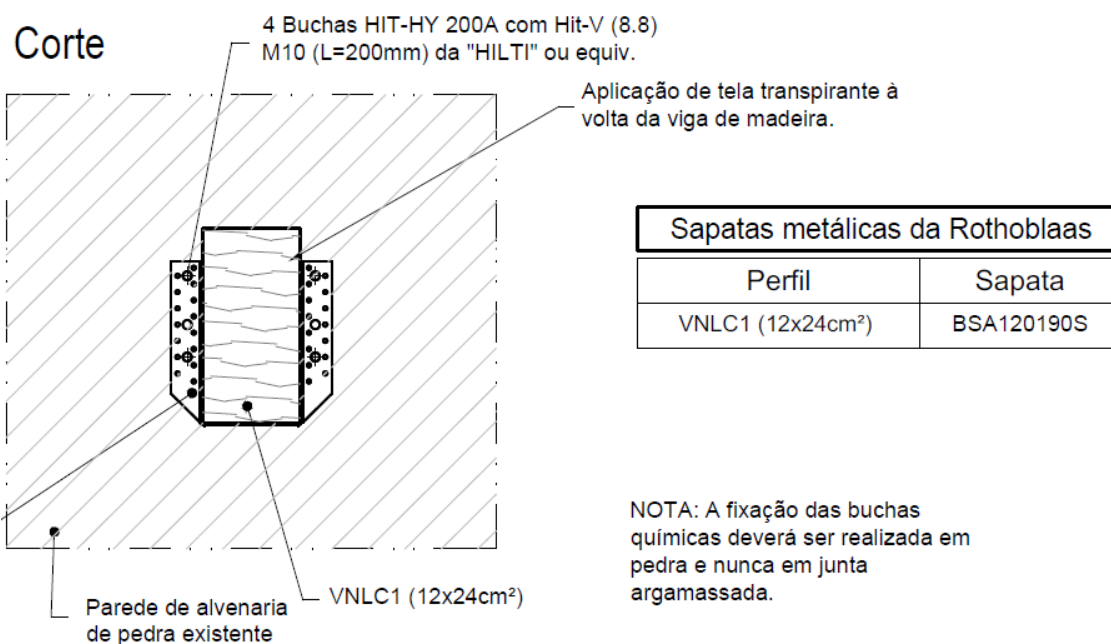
Corte do pormenor de ligação de viga de madeira com parede de alvenaria através de sapata metálica (NCREP, 2018)
